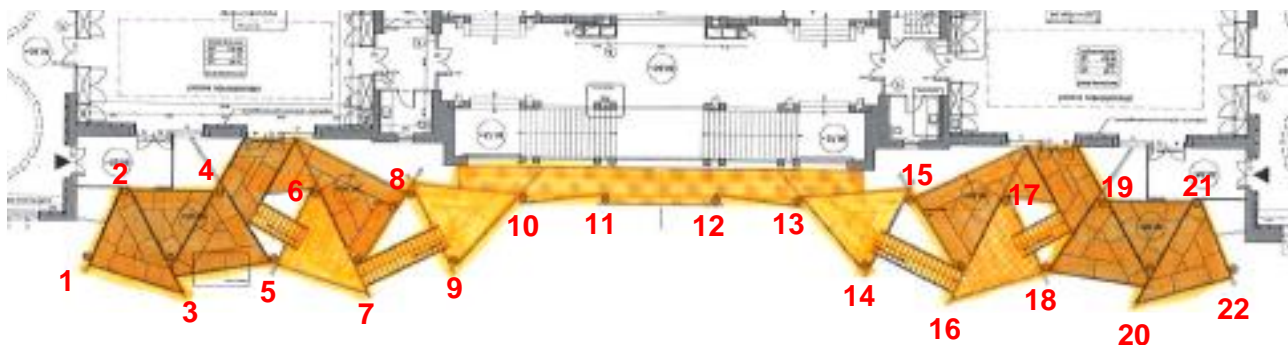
Vue en plan escaliers et terrasses façade arrière
